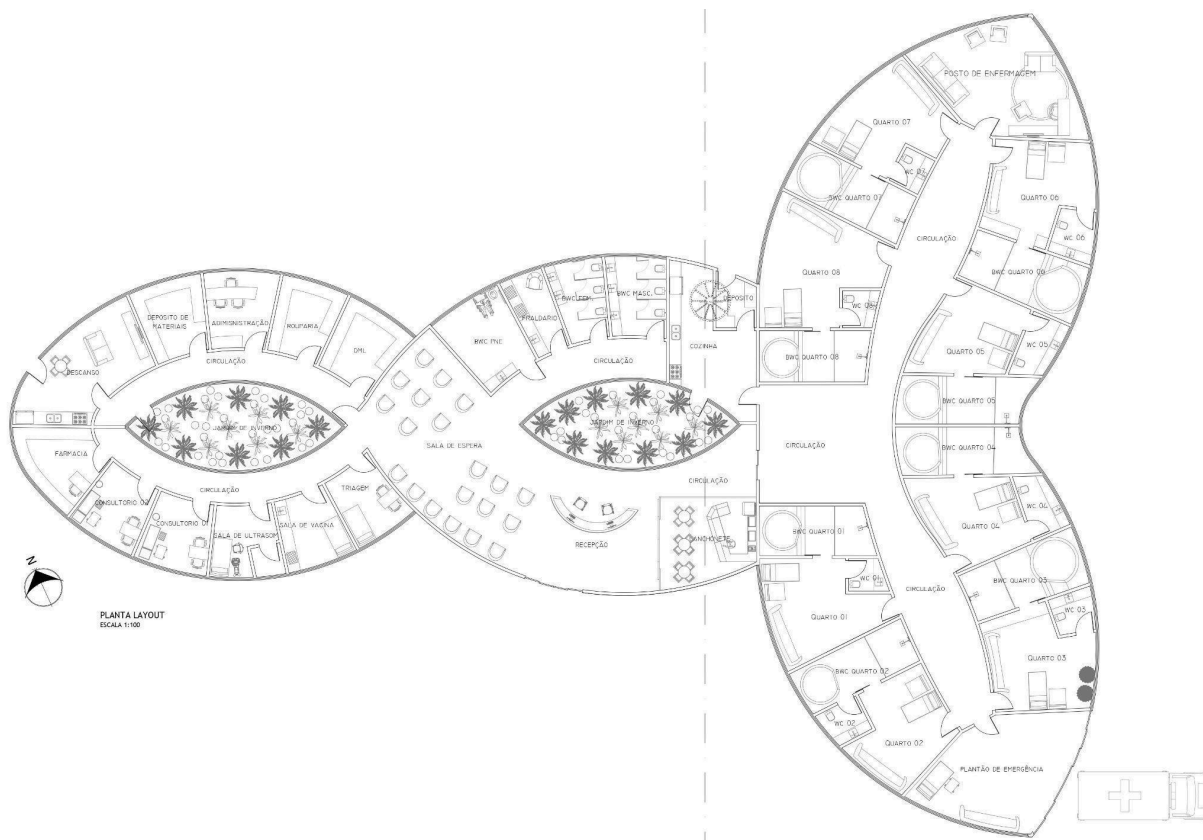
PLANTA BAIXA - ENSAIOS GRÁFICOS
